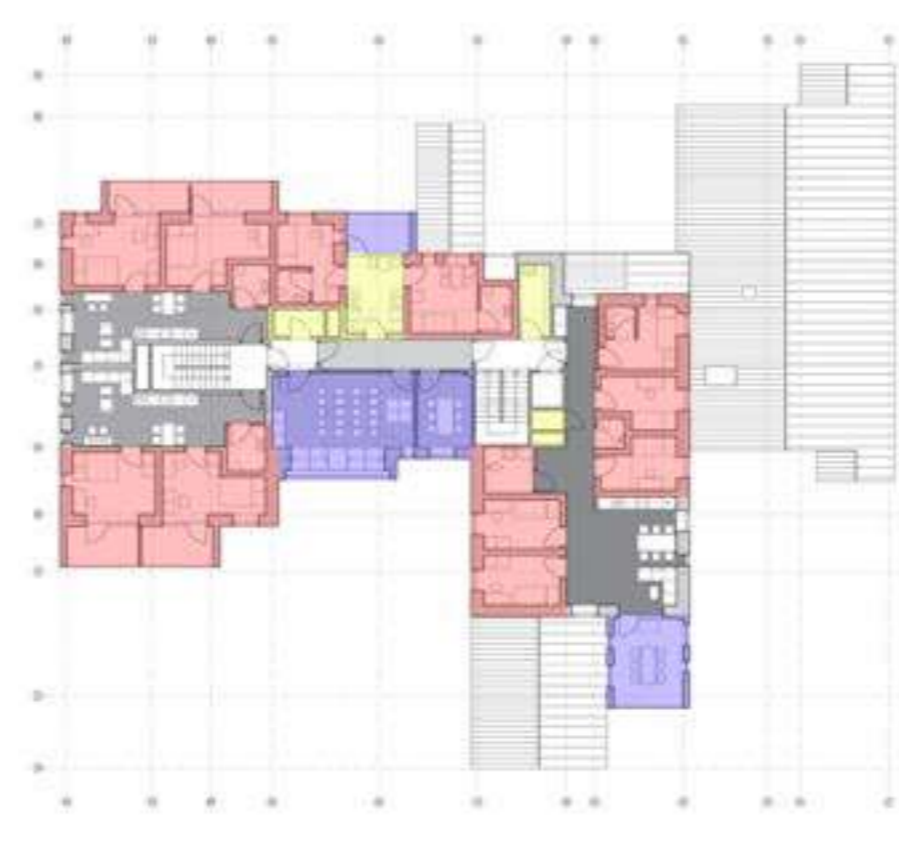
Planta do Segundo Pav. Fonte: Archdaily
